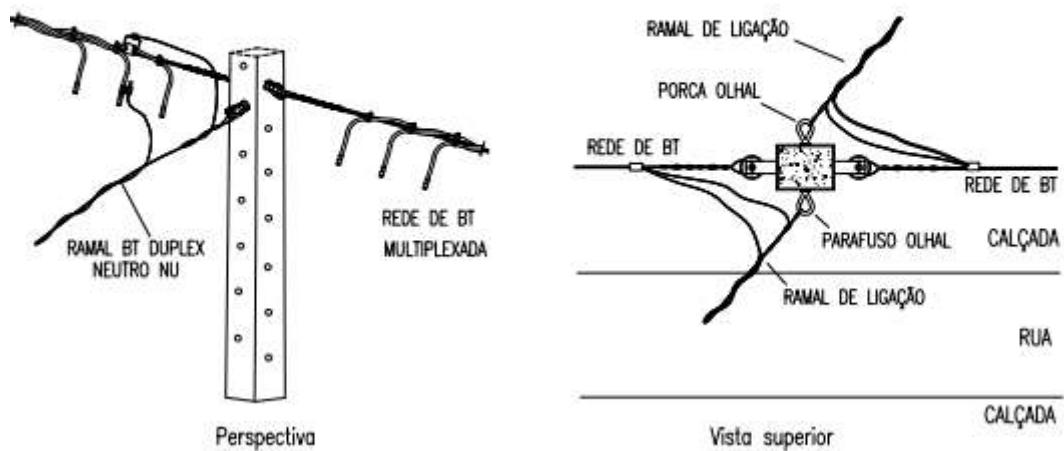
Amarragens e ligações – Secundário – ligação dos ramais de serviço
